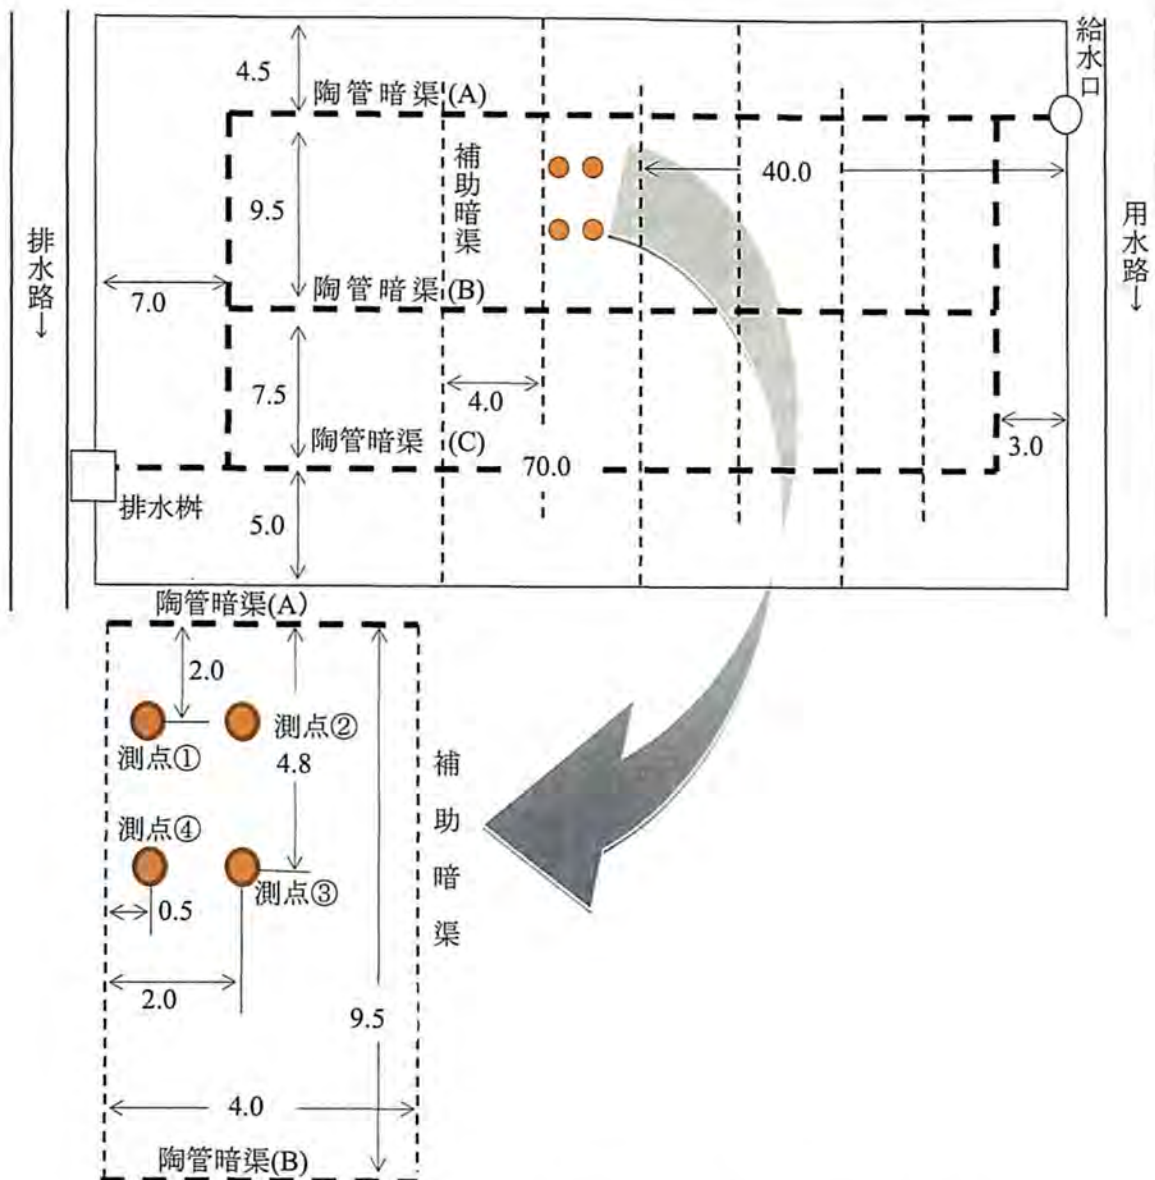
地下灌漑・排水試験（連結暗渠区）の平面図（単位 m）
